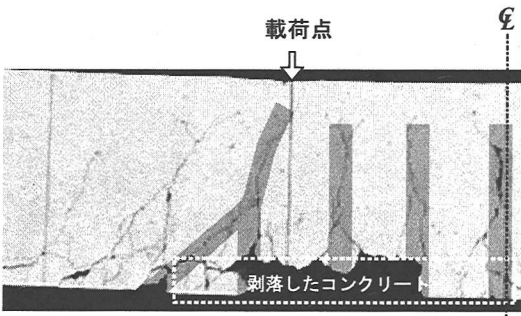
実験終了時の試験体状況 (A-250-1 試験体)
